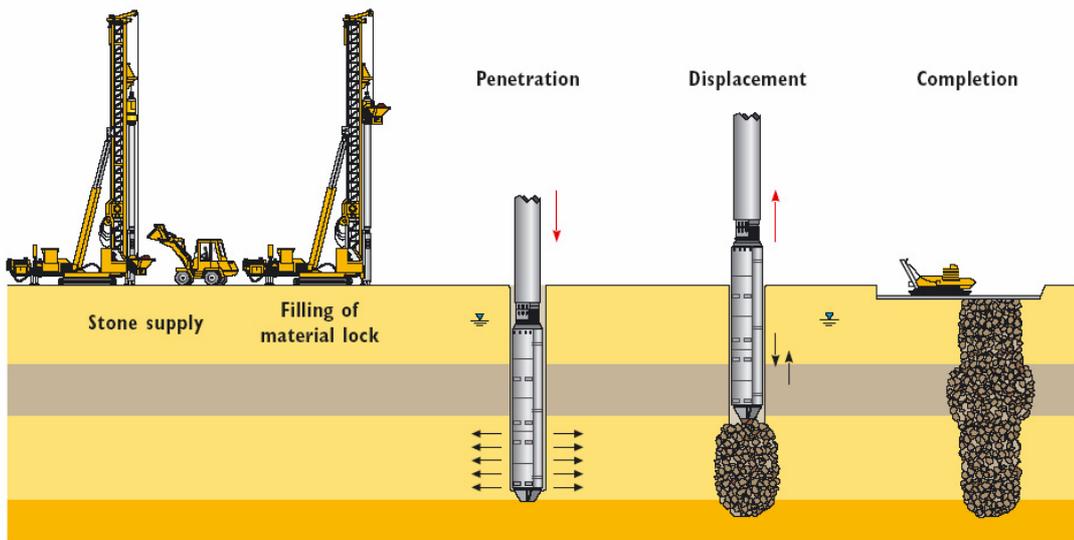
Esquema de construcción por vía seca (Raju et al., 2004)
